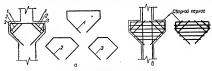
101. Армирование консолей: а — вязаной арматурой; б — сварными каркасами.
